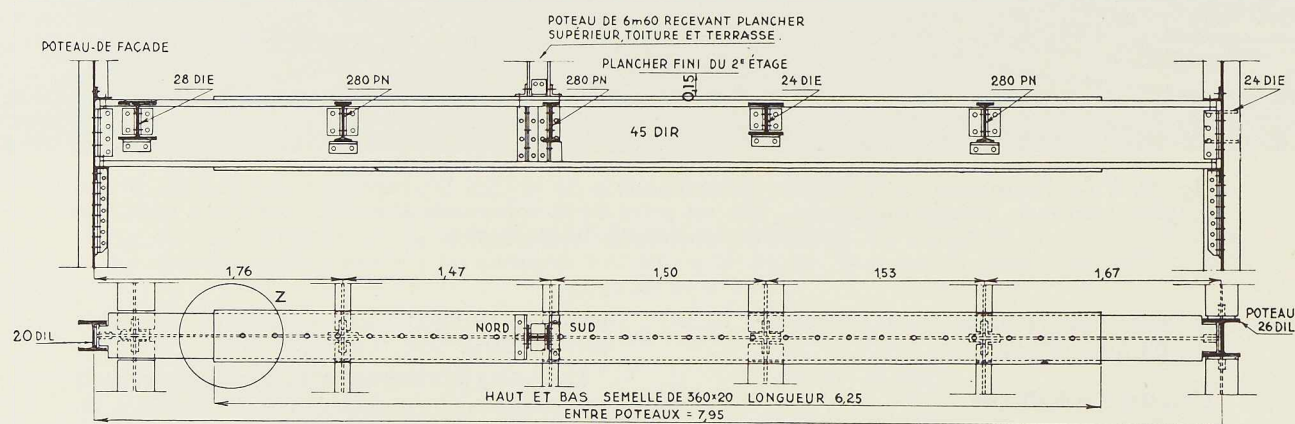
Une des poutres couvrant les salles de restaurant et recevant une colonne supérieure fortement chargée.
